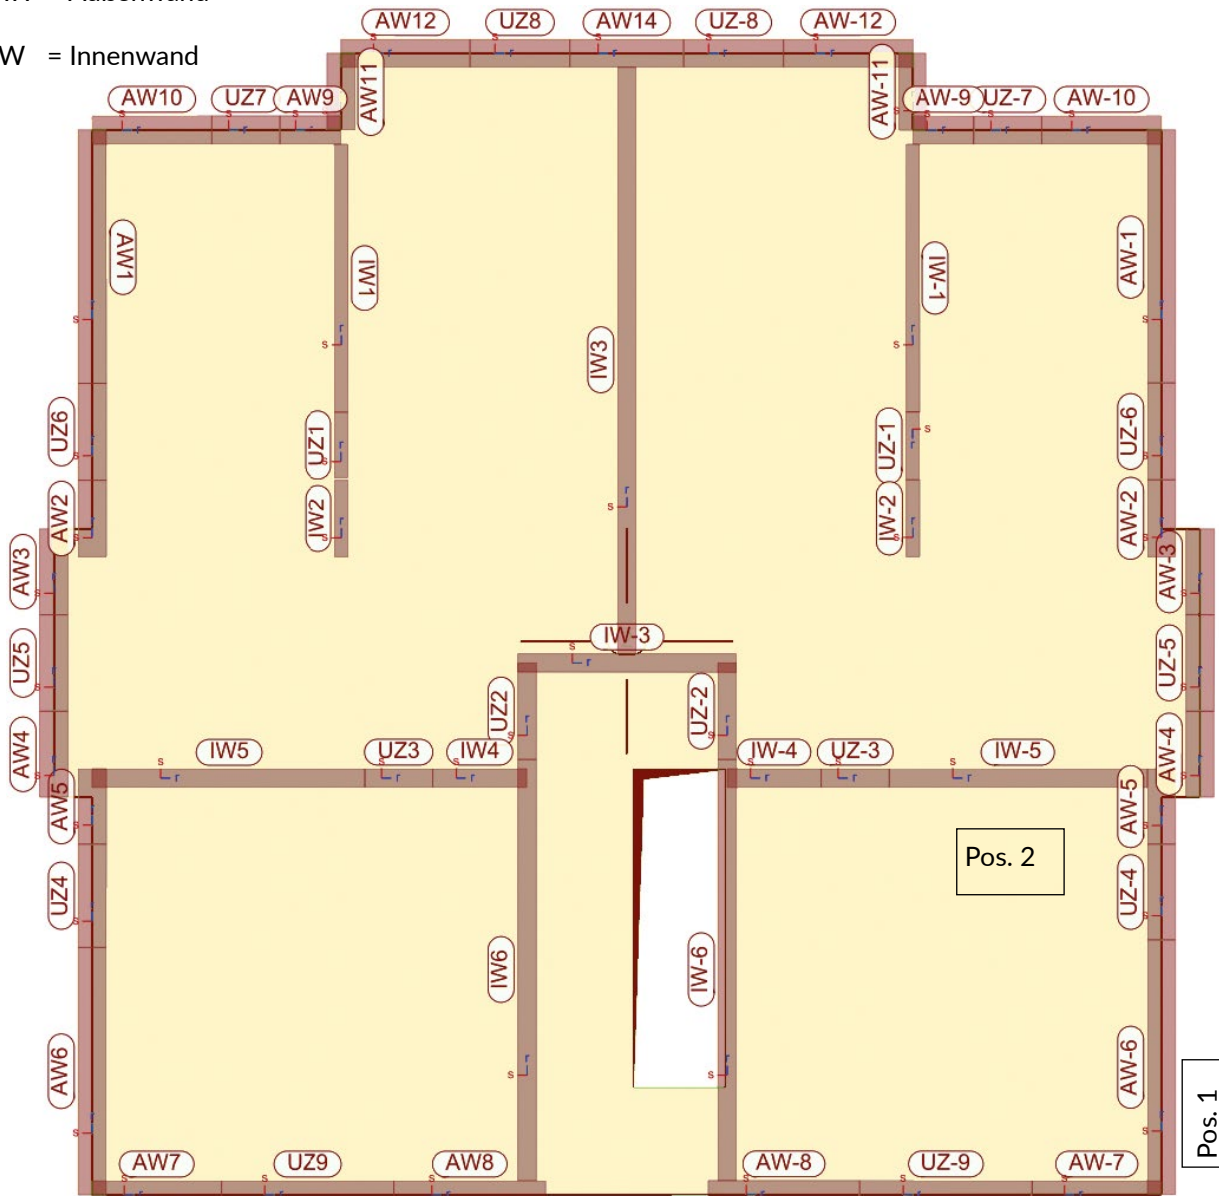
Grundriss und Wandbezeichnungen
